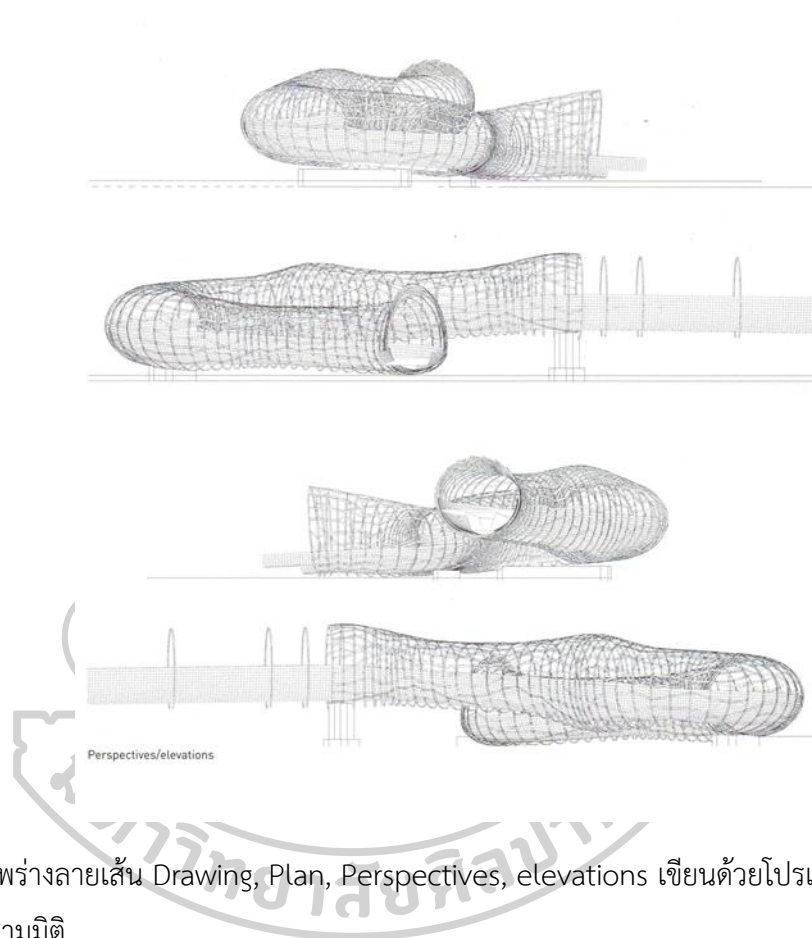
ภาพร่างลายเส้น plan, perspectives และ elevations
